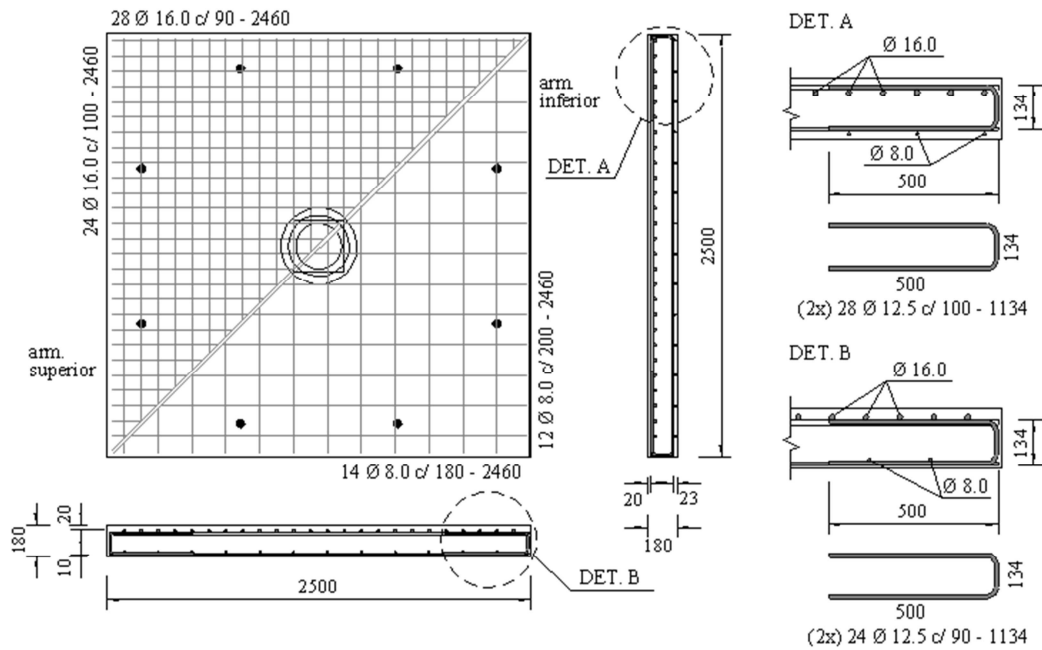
Projeto de armaduras de flexão das lajes (Ferreira, 2010)
